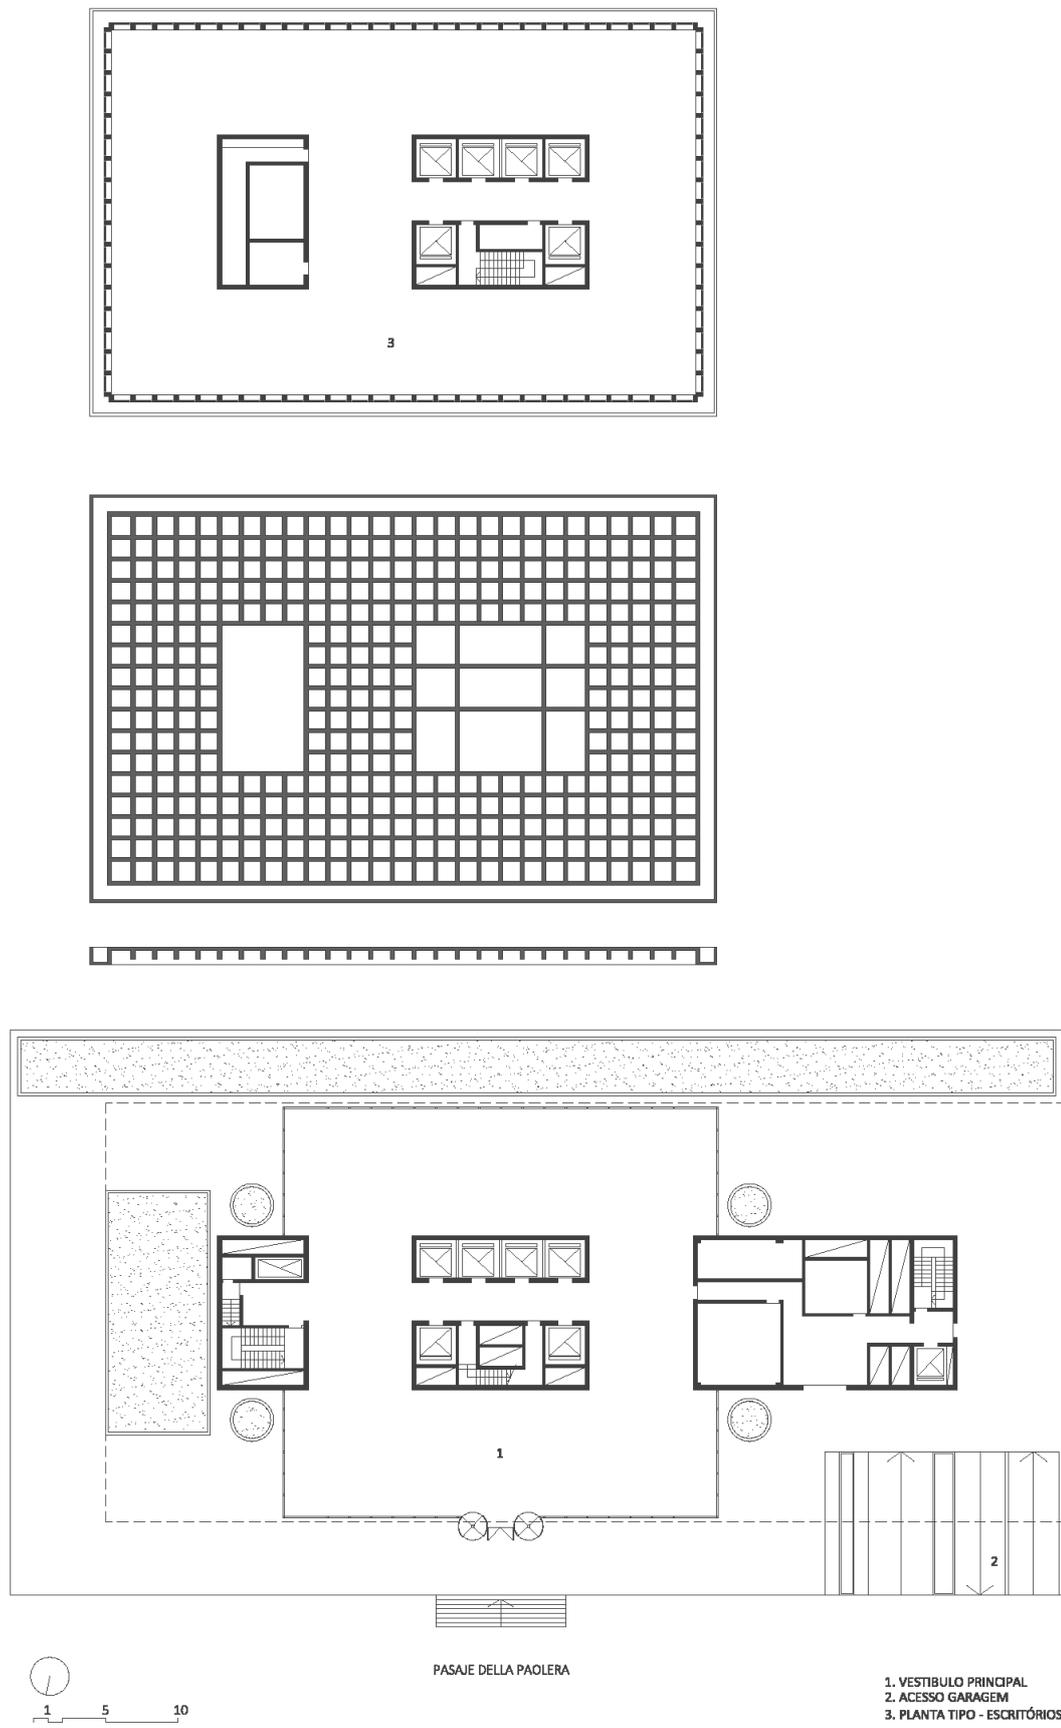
De cima para baixo: Planta tipo, Planta de formas do tipo, Planta Térrea, Torre IBM, 1979-1983.
